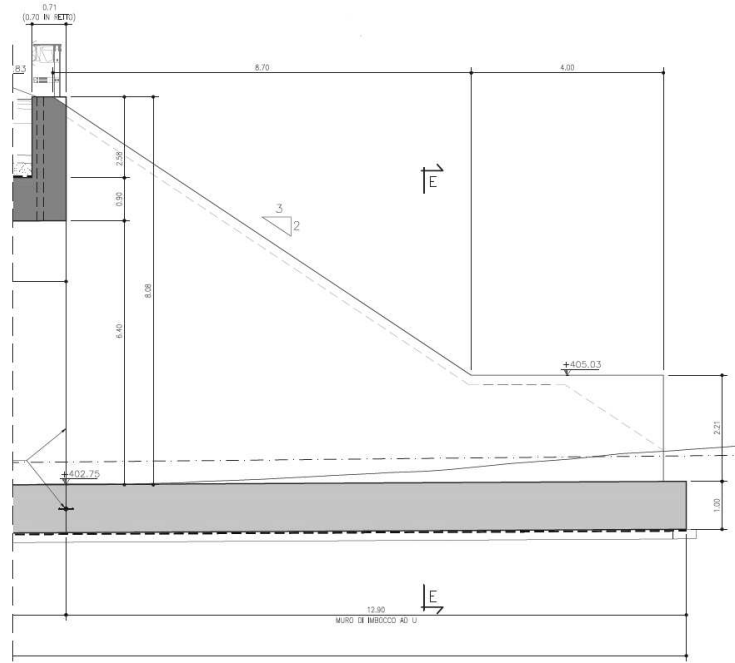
Muri d'imbocco - Sezione longitudinale
